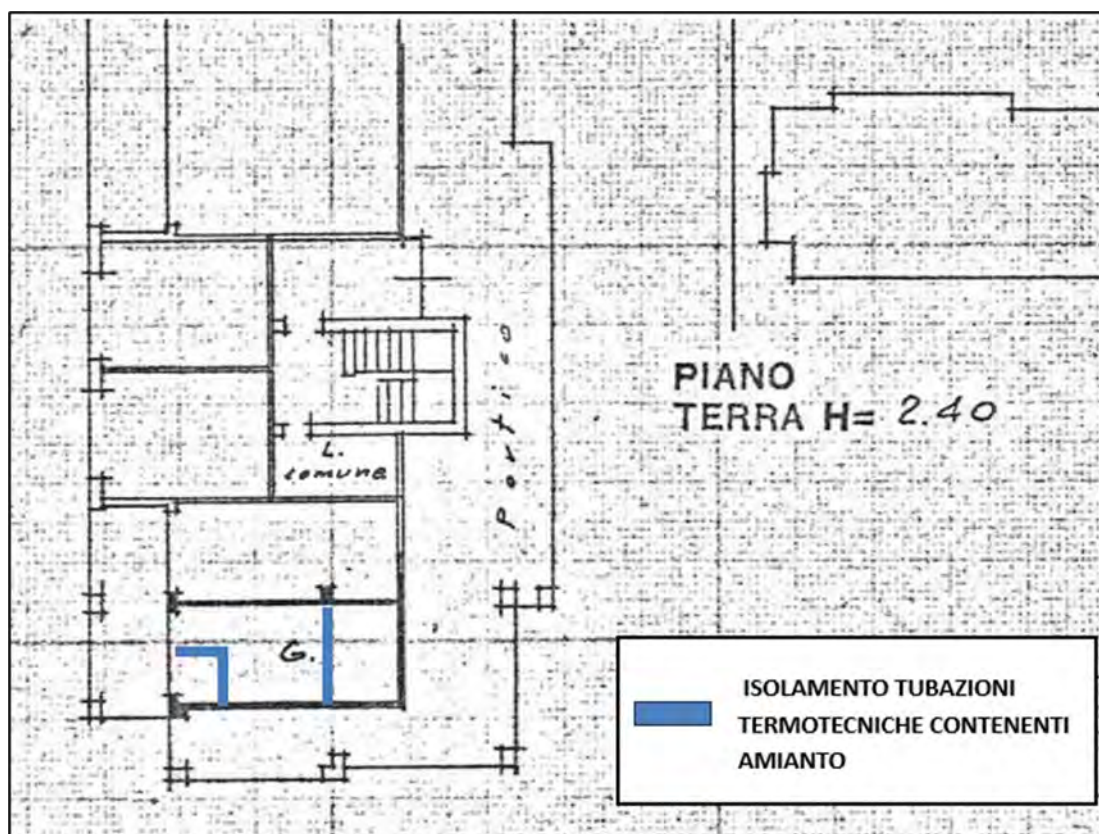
planimetria garage piano terra con isolamento tubazioni contenenti amianto
